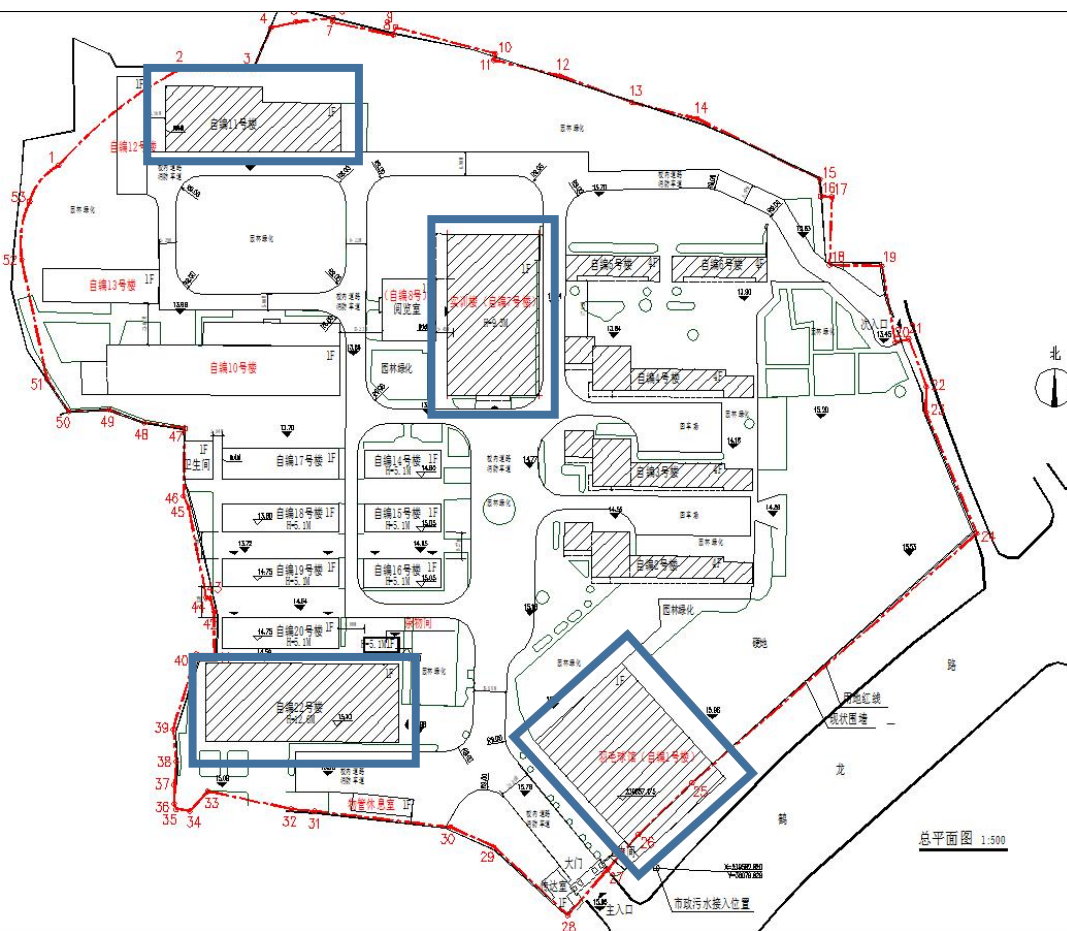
现有建筑总平面图（标注框为保留建筑）
